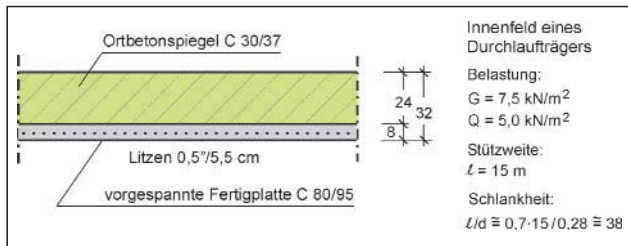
Beispiel einer vorgespannten Elementdecke nach DIN 1045-1 [9]
